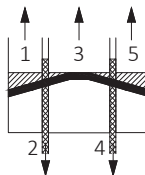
Mögliche Verformungsfigur eines vierschnittig beanspruchten Stiftes einer Stahlblech-Holz-Verbindung mit dünnen Stahlblechen und geringer Seitenholzdicke. (Siehe Fall k in Bild E15-4)
